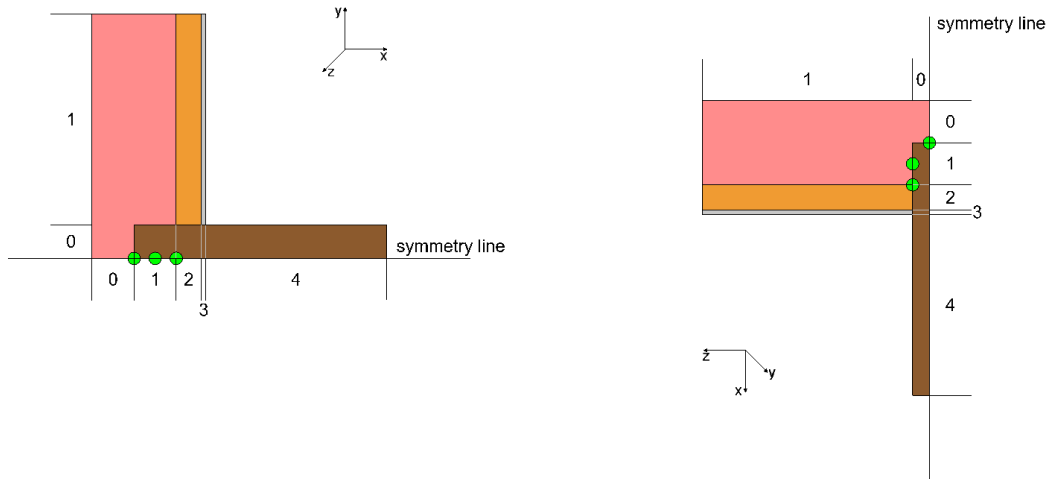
Nummerierung der Schichten: links Vertikalschnitt, rechts Grundriss
